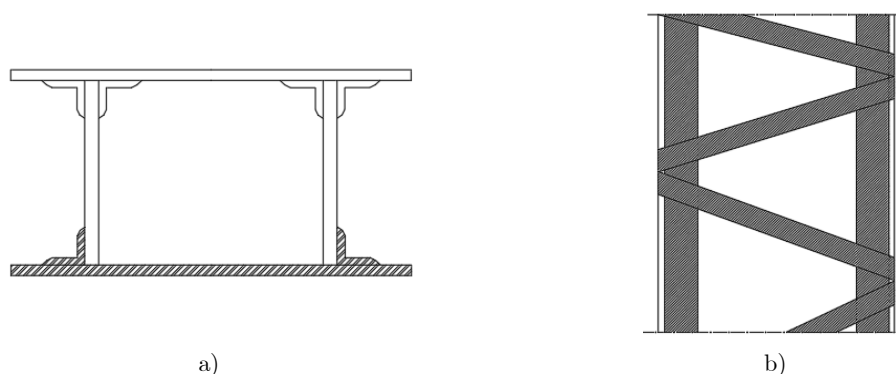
Solução de reforço com adição de novas cantoneiras e réguas metálicas: a) Seção transversal e b) Vista inferior (adaptado de [Gil, 1979]).
